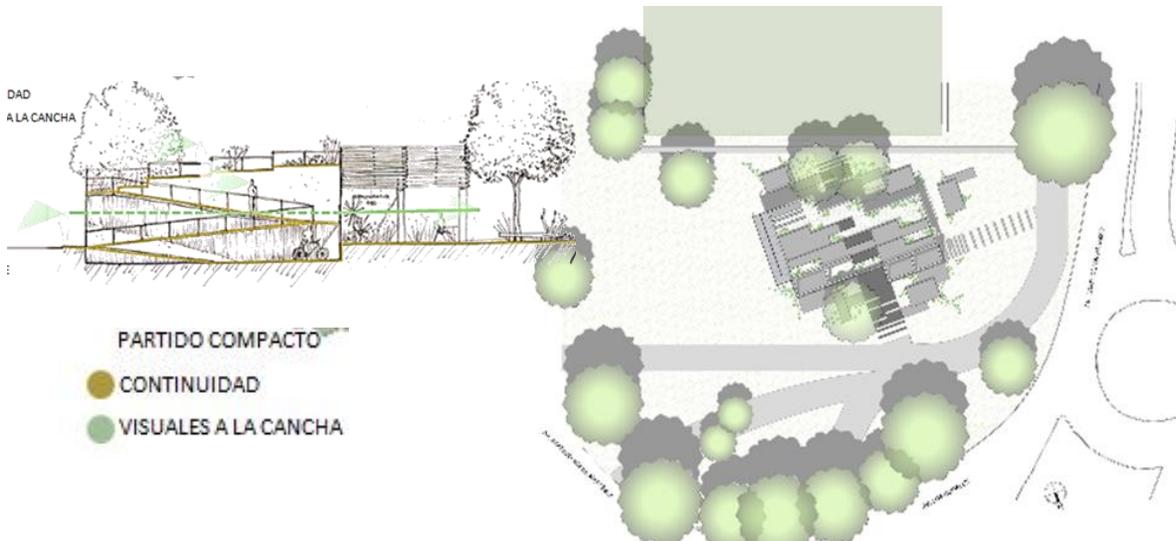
Planimetría del sector y esquema de Corte. La volumetría se emplaza cruzada en el lote, buscando la orientación Norte plena de su frente más extenso. Desde el corte se proponen operaciones que permiten incluir la cubierta del edificio como un espacio privilegiado para el reconocimiento de su entorno.
